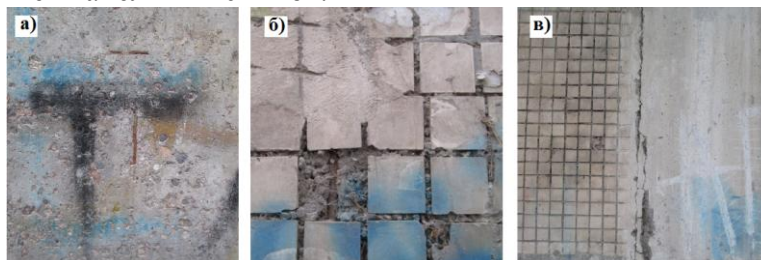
Дефекты и разрушения в панельных зданиях: а – оголенная арматура в панели; б – повреждение отделочного слоя и ржавчина на оголенной арматуре; в – разрушение межпанельного стыка
